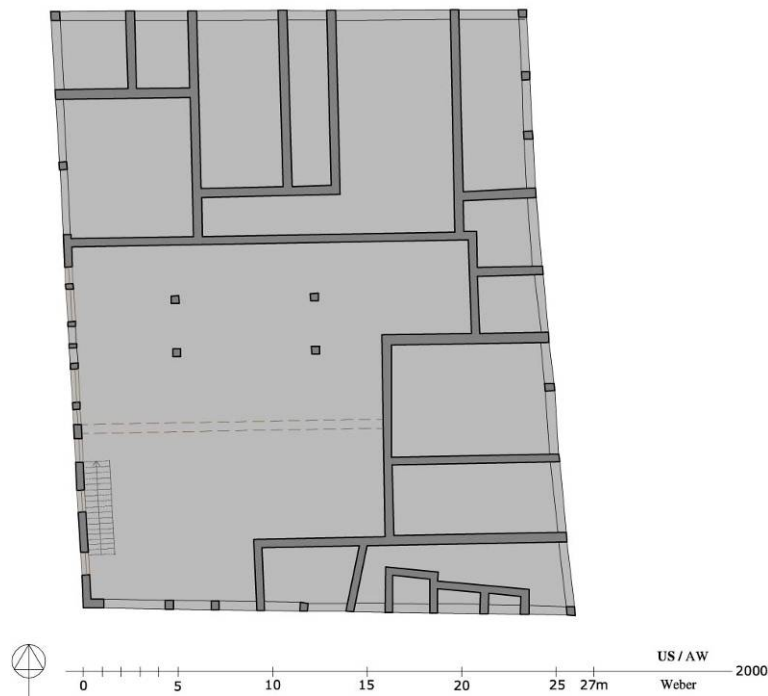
Osmanische Bank, Grundriss EG
